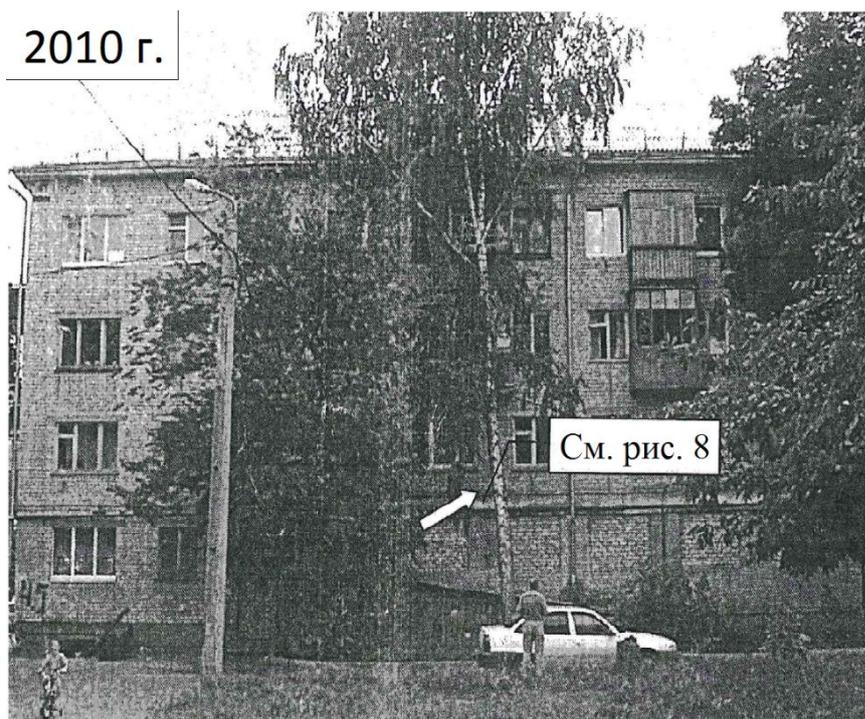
Фасад жилого дома с магазином на первом этаже со стороны двора (западная часть здания).
